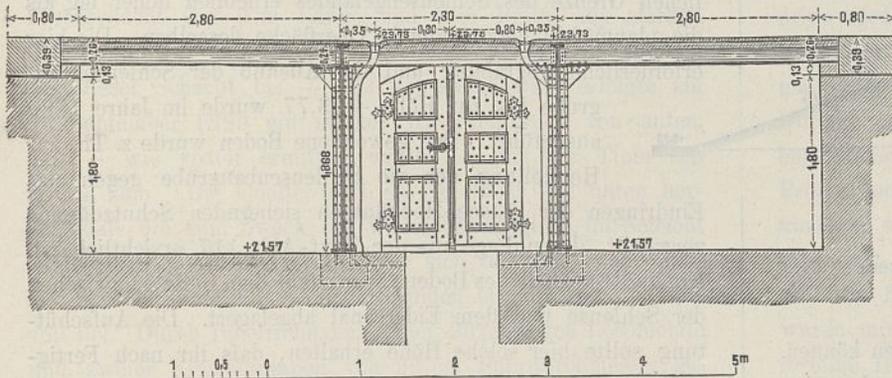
Querschnitt durch die Maschinenkammern im Außen- und Innenhaupt der Schleusen-Mittelmauer in Holtenu.
